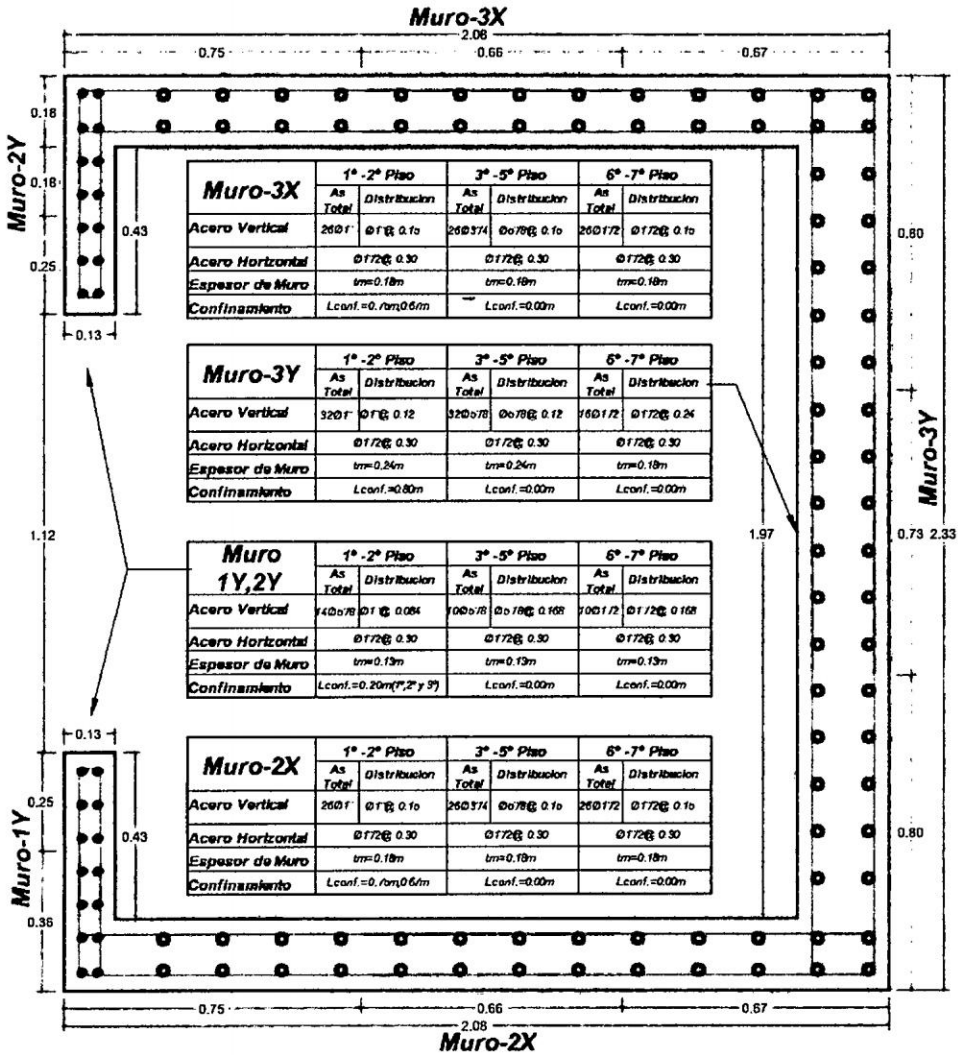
Sección final del muro de concreto armado de la caja del ascensor
